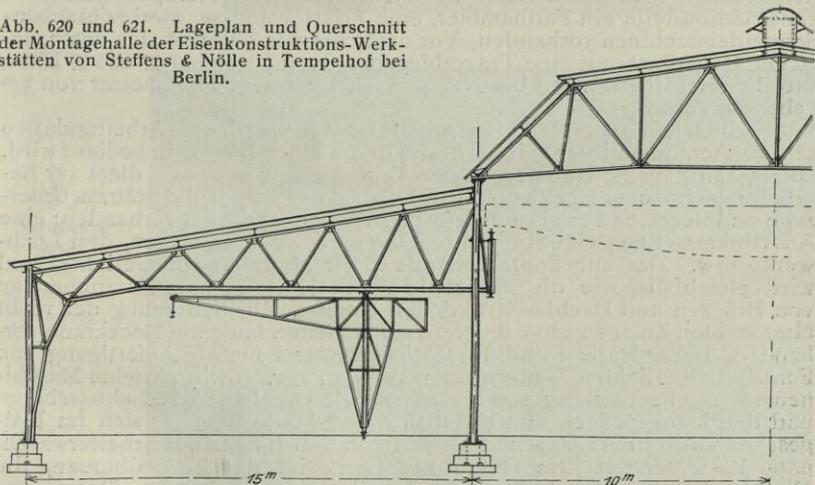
und 621. Lageplan und Querschnitt der Montagehalle der Eisenkonstruktions-Werkstätten von Steffens & Nölle in Tempelhof bei Berlin.
